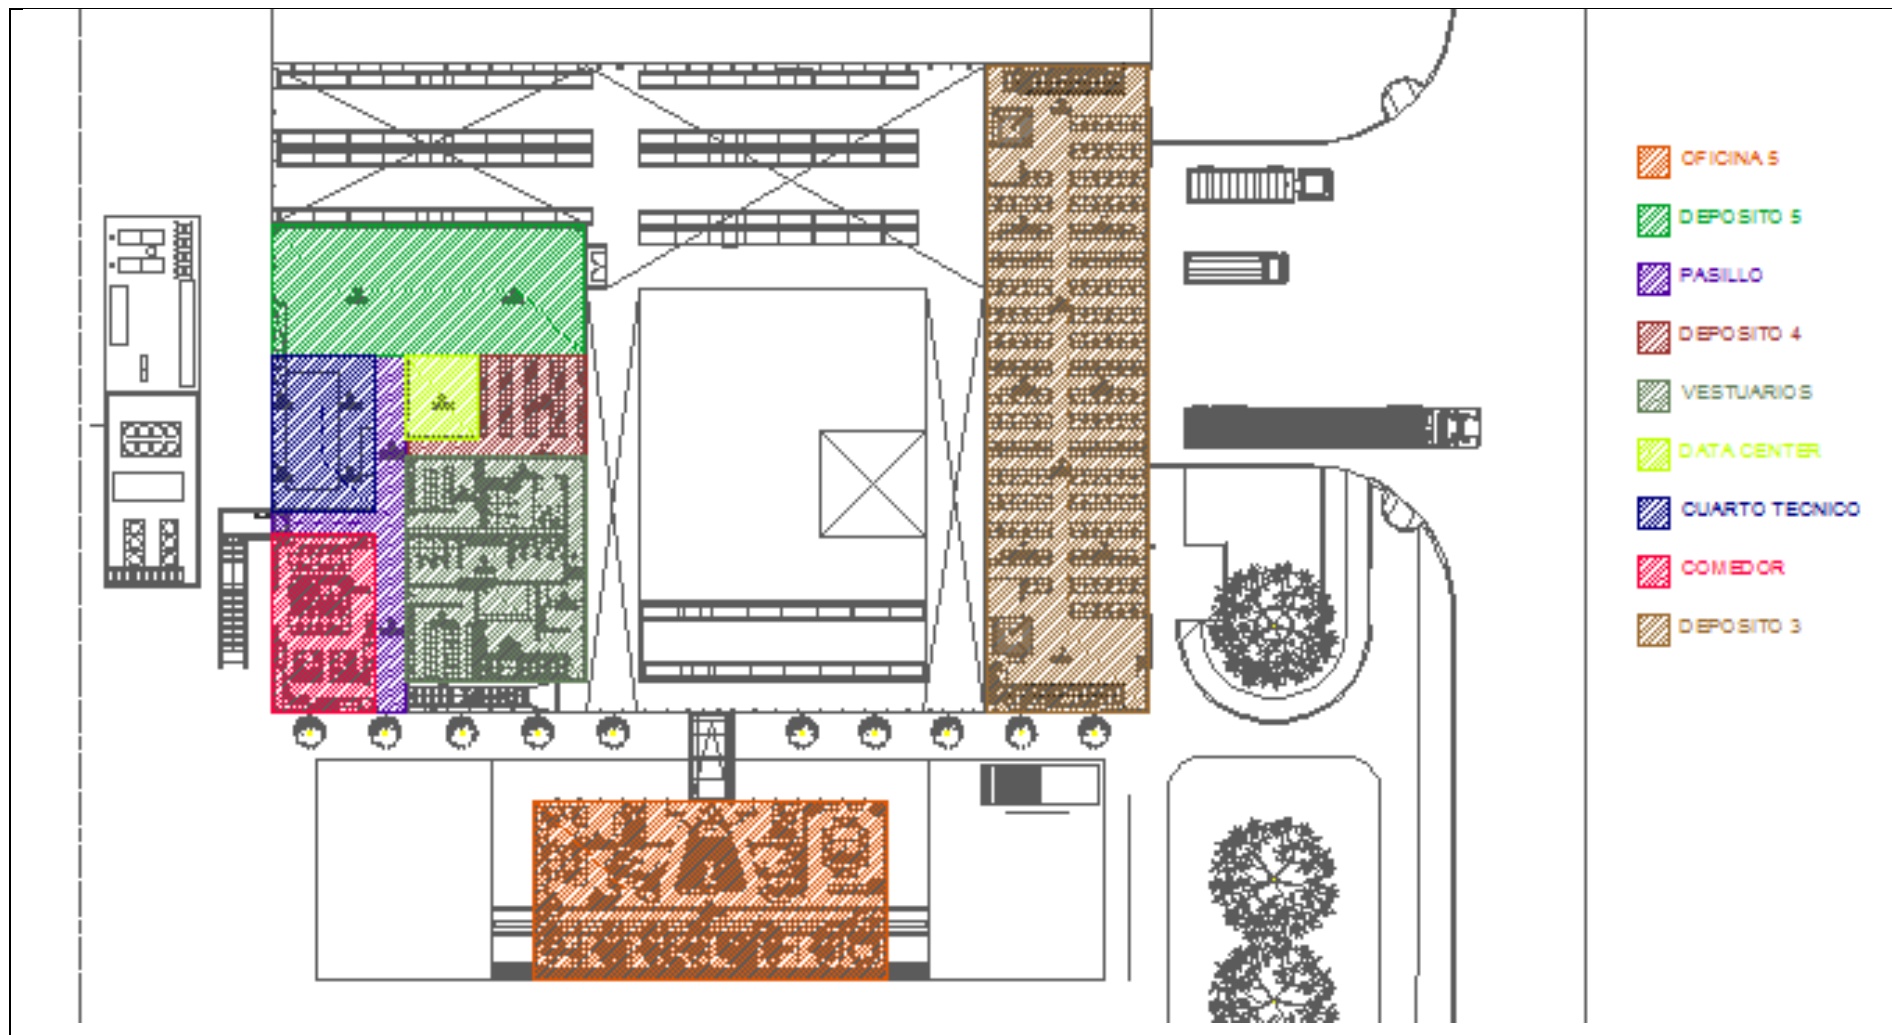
Plano de planta del laboratorio con divisiones por sectores correspondiente a Primer Piso
